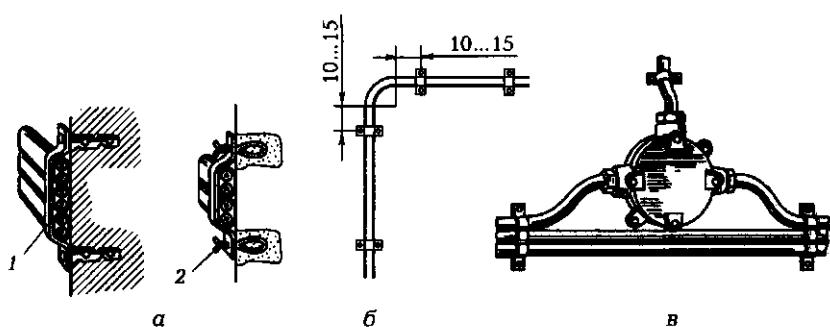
Монтаж электропроводок проводами и кабелями с резиновой и пластмассовой изоляцией:
